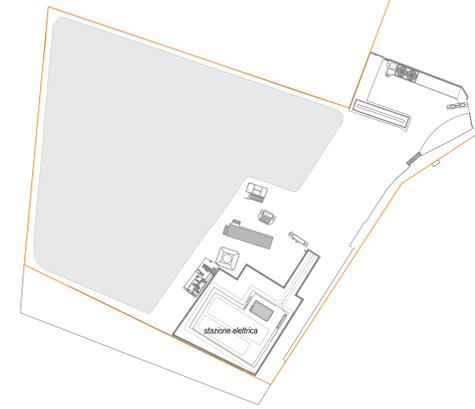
Individuazione alternative di progetto - Dettaglio siti (Scala 1:20.000)
